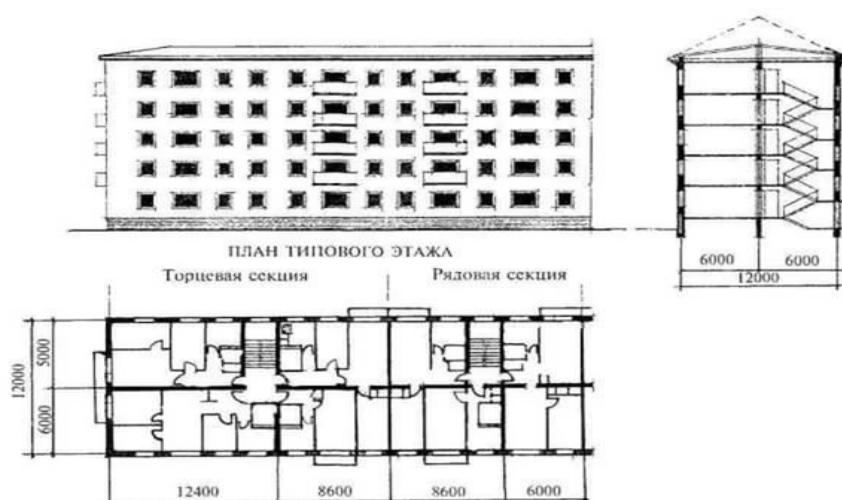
План, фасад, разрез многоквартирного жилого дома
